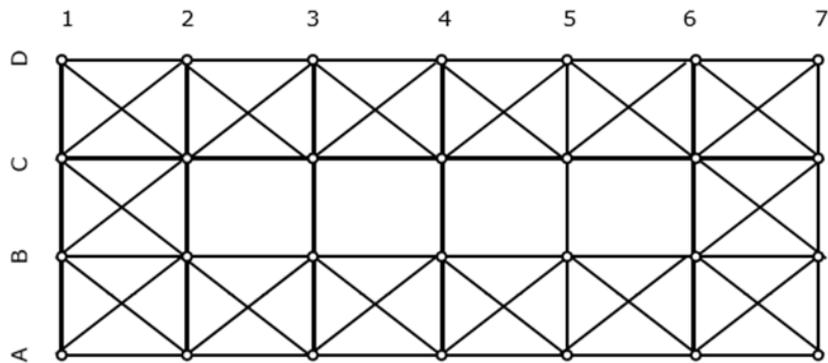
Structure avec contreventement horizontale (plan d'une toiture contreventée)
